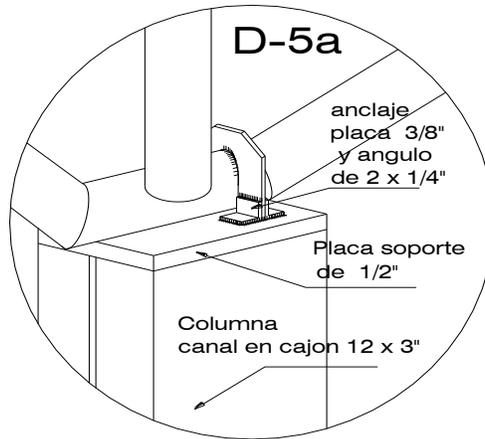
Conexión y fijación de la armadura con las columnas.
